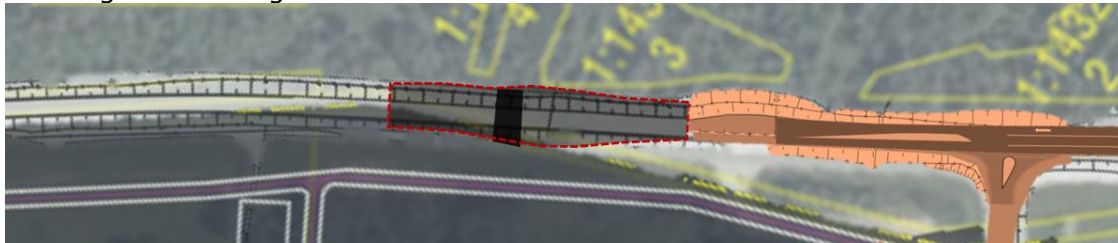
Fyra möjliga utredningslägen för tunnel under E12.
